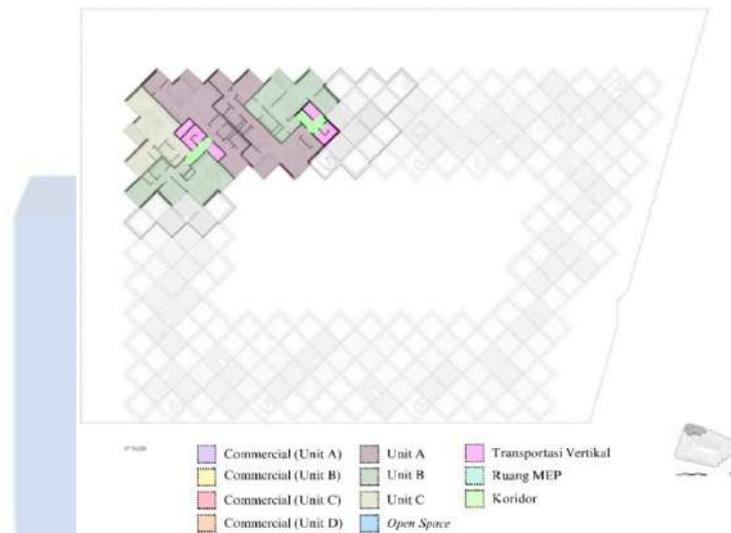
Denah 6th Floor 79 & Park Residences
